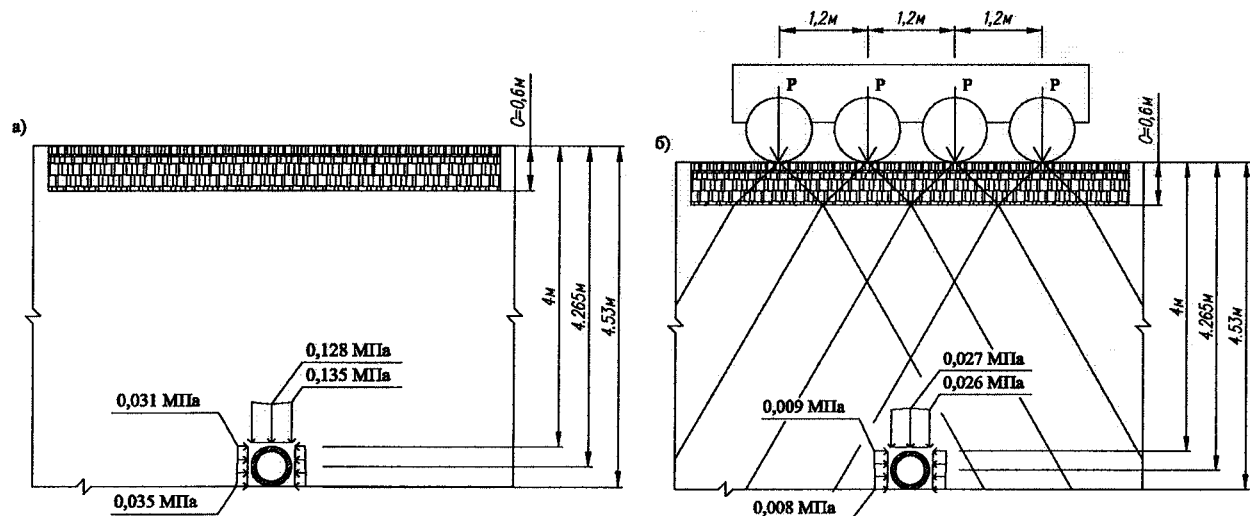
Сбор нагрузок на конструкцию: а – нагрузки, действующие на конструкцию от вертикального и горизонтального давления грунта; б – вертикальное и горизонтальное давление грунта на конструкцию от временной нагрузки НК-80 (при расчётной высоте засыпки грунтом 4 метра)
